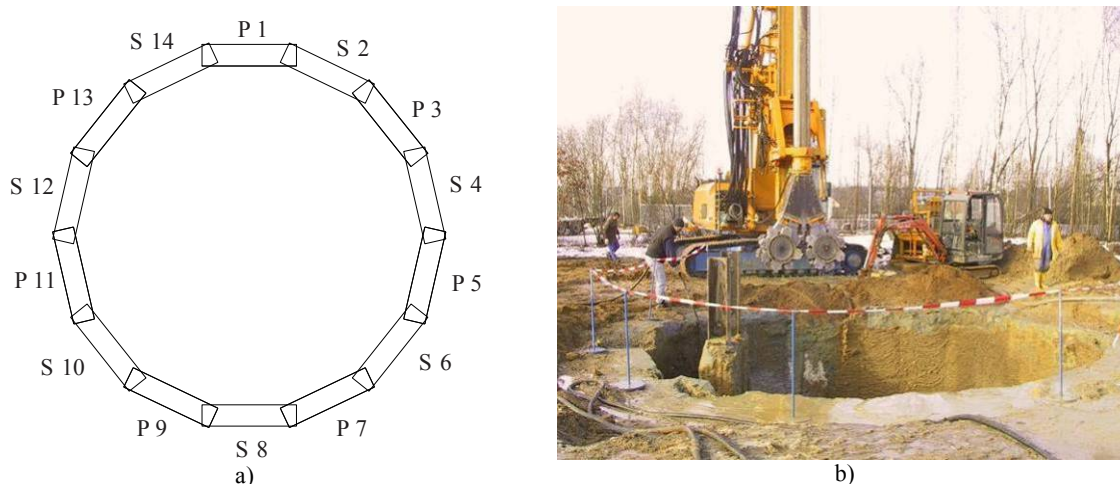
Poço construído com a tecnologia CSM, em Aresing: a) esquema de disposição dos painéis (P – primário; S – secundário) (adaptado de Fiorotto *et al.*, 2005); b) aspecto geral da obra (Bauer, 2008)
